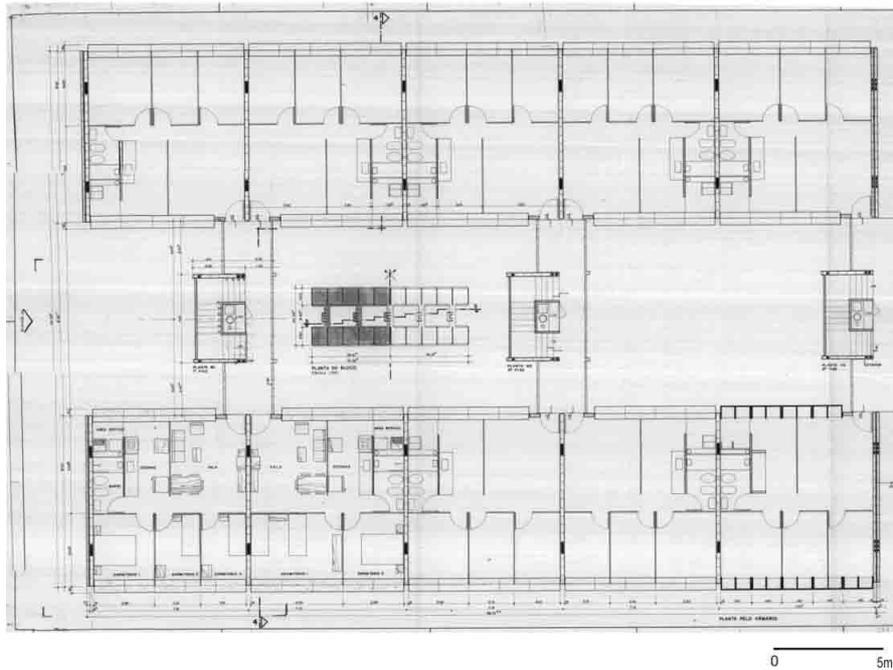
Planta del piso tipo 1ª etapa (Fuente: <sup>5</sup>)
